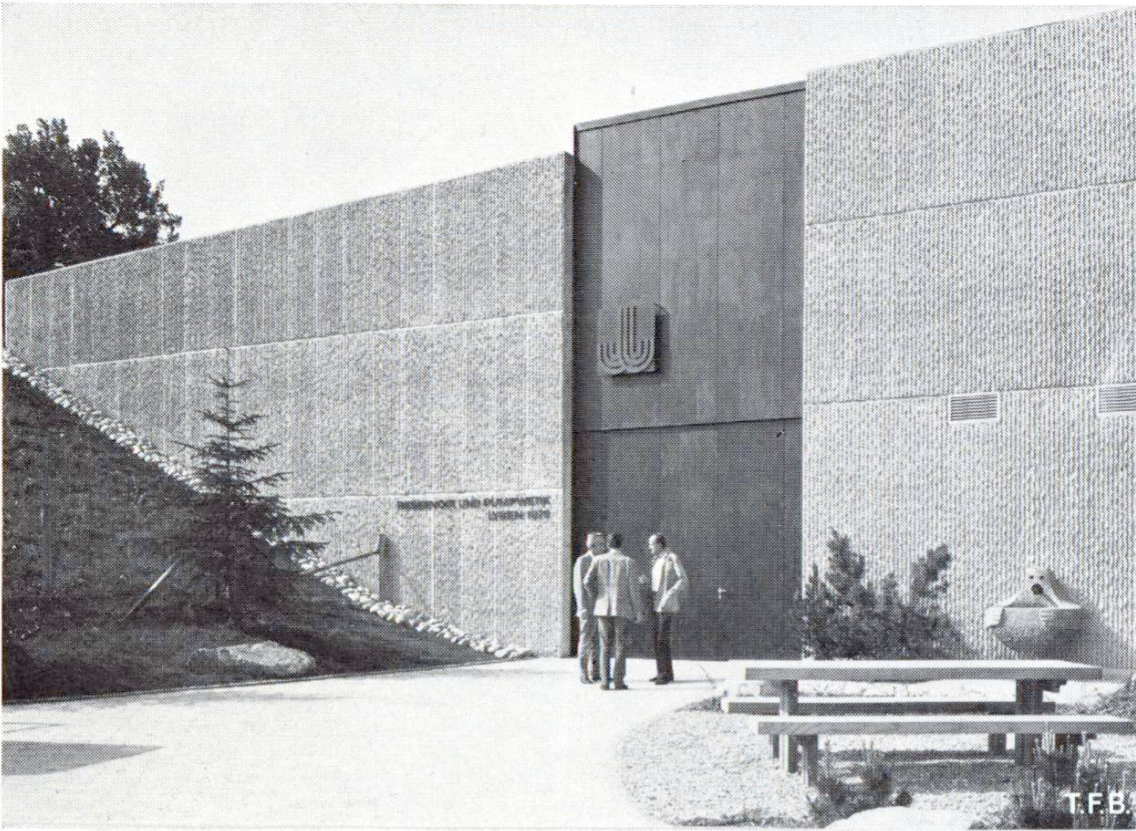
Façade du bâtiment avec béton à surface cannelée (béton coulé sur place).
